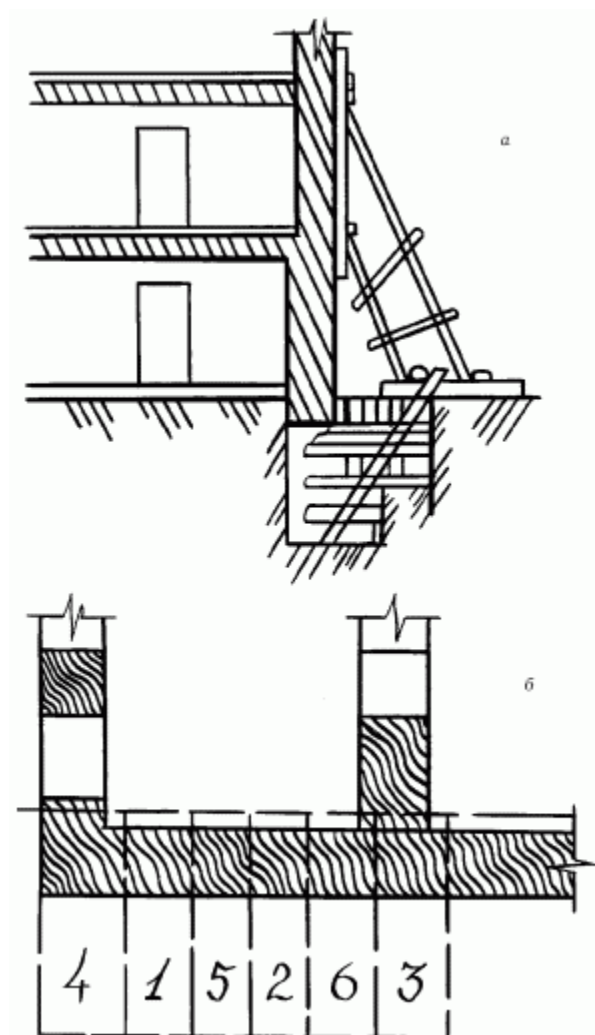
Подведение нового фундамента под старые стены: а – укрепление стены подкосами; б – последовательность действий.
